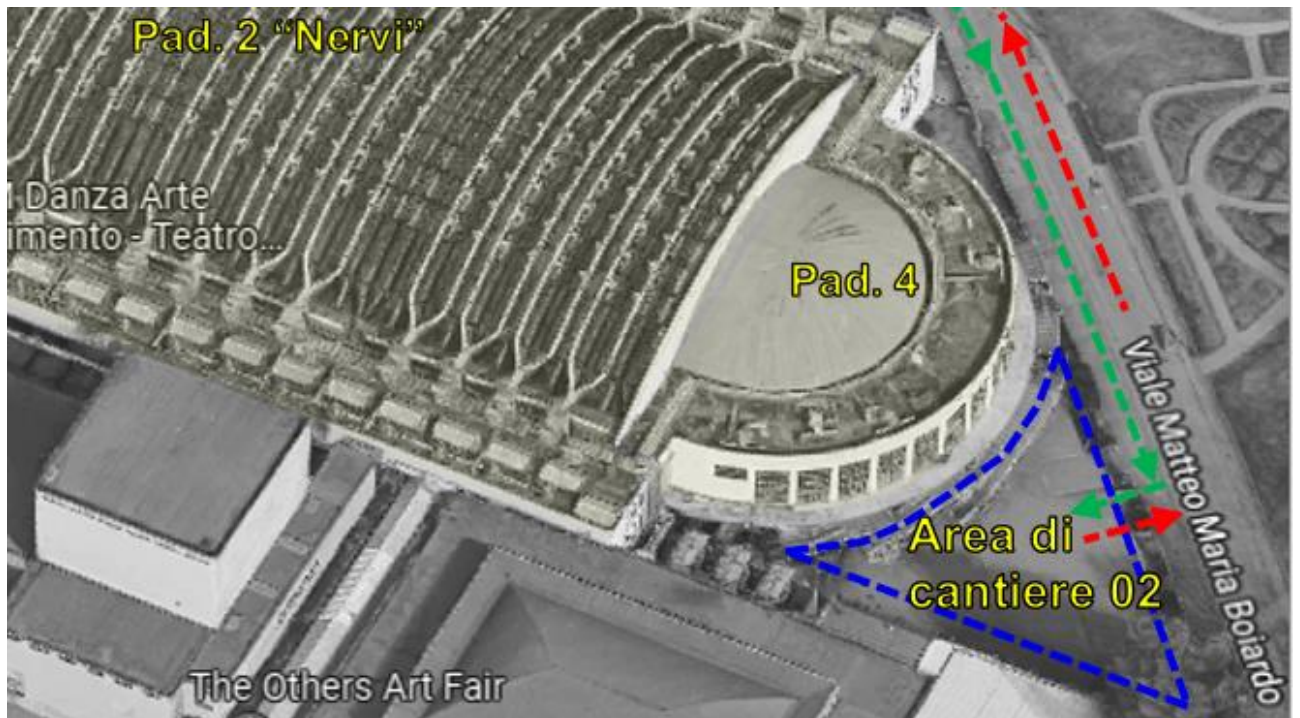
Dettaglio area di cantiere 02 nel cortile lato Viale Mauro Maria Boiardo
